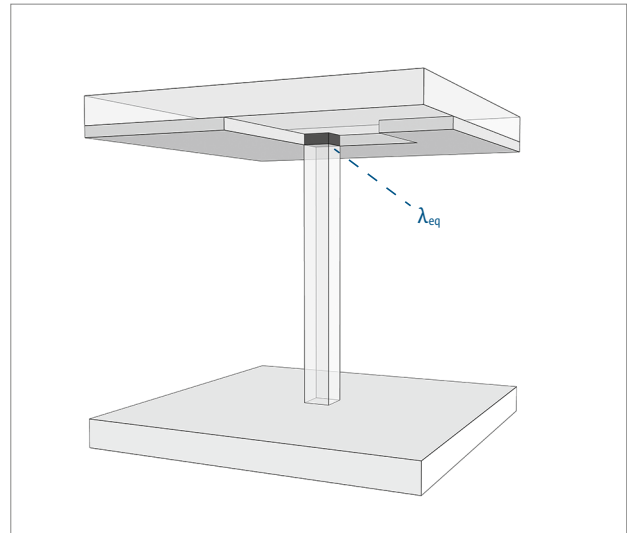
Anschlussdetail mit vereinfachtem Ersatzdämmkörper
